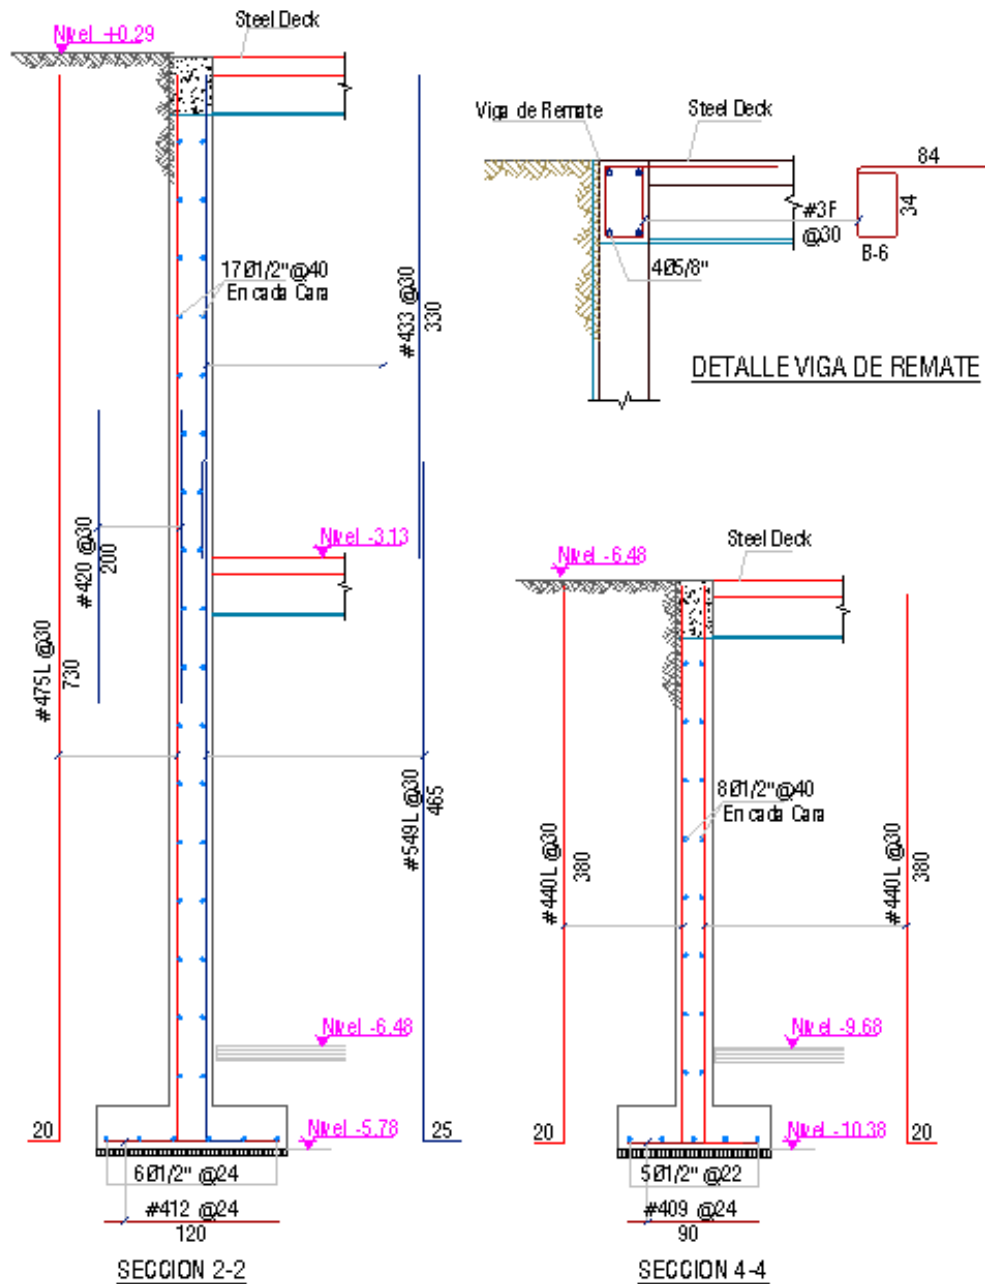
Secciones de muros de contención en sótano 1 y Planta baja. Fuente Estrumetal.
